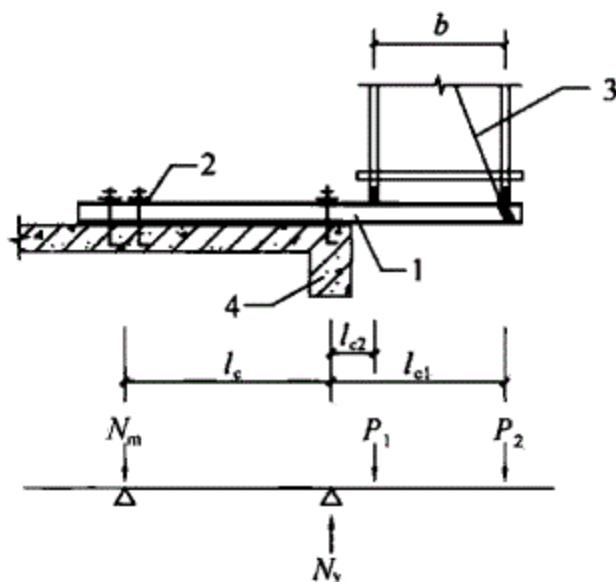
悬挑脚手架型钢悬挑梁构造与计算示意图
